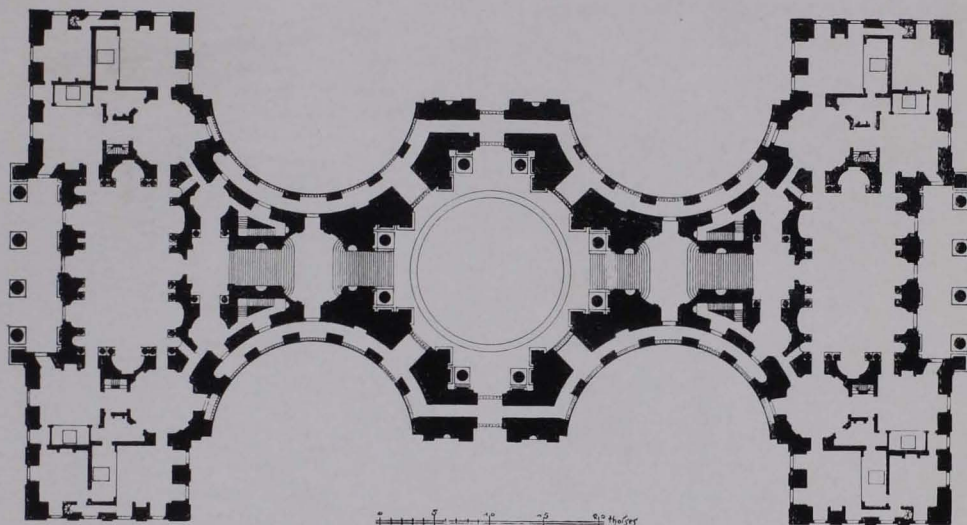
Antoine Lepautre (1621—1691), Grundriß zu Entwurf D 4 u. 5 1652
